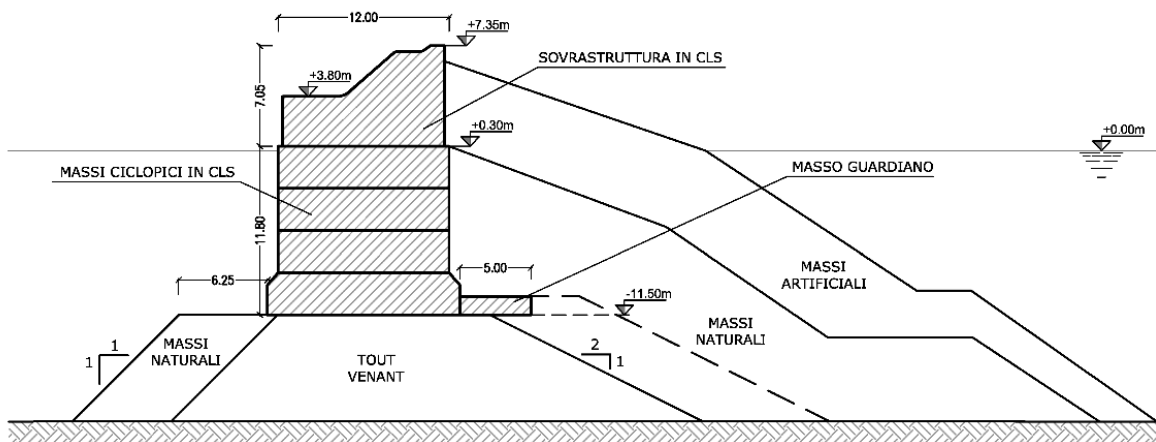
SEZIONE TIPO DEL TRATTO A PONENTE DA DEMOLIRE – TRATTI C’-D’, D’-D
